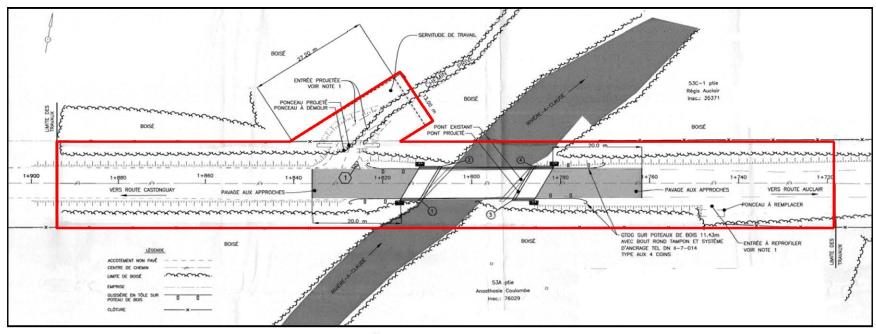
Localisation du secteur inventorié, projet n° 154-01-0055 (source : Ministère des Transports, plan d'ensemble [extrait], Voirie – Plan et profil - Implantation, Plan PO-2010-1-10993 (7/7), 10 mai 2010)
